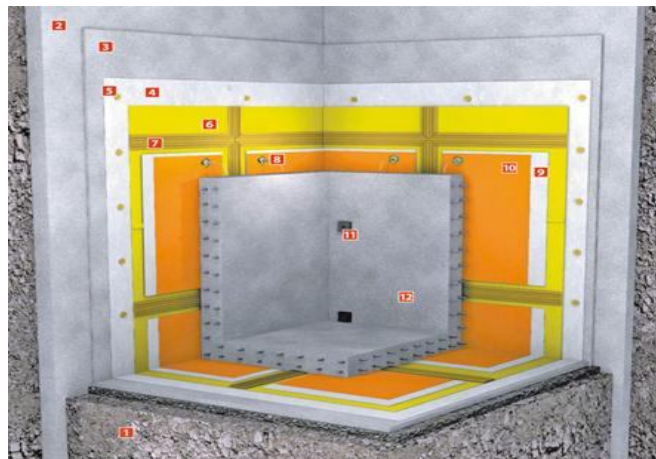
Система ТН-ФУНДАМЕНТ Проф: 1 – ґрунт; 2 – «стіна в ґрунті», огорожа котловану; 3 – вирівнюючий шар; 4 – захисний (підкладковий) шар – геотекстиль ТЕХНОНІКОЛЬ; 5 – кріпильний елемент – ПВХ Рондель; 6 – полімерна мембрана LOGICROOF T-SL; 7 – гідрошпонка ТехноНІКОЛЬ; 8 – ін'єкційний штуцер; 9 – демпферний шар – геотекстиль ТЕХНОНІКОЛЬ; 10 – поліетиленова плівка ТЕХНОНІКОЛЬ; 11 – вивід ін'єкційних трубок в інтер'єр; 12 – Внутрішня несуча конструкція
